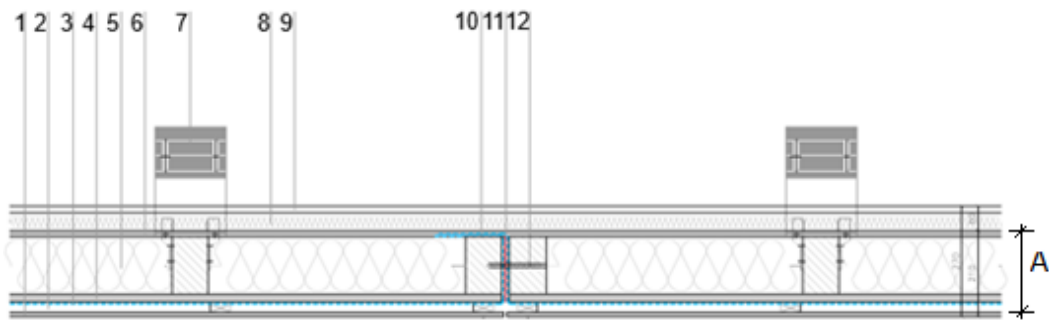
Sección horizontal. Unión de módulos prefabricados.
